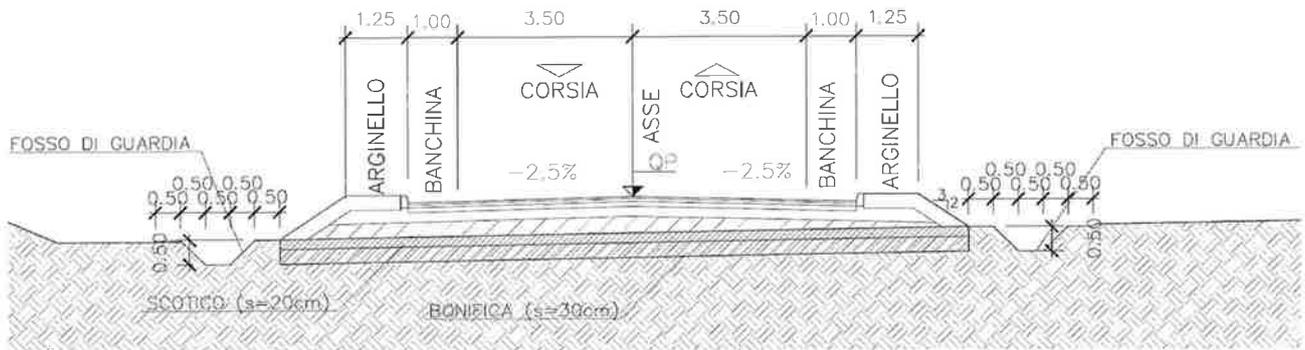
Sezione tipo "locale a destinazione particolare" (D.M. 5/11/2001) in rilevato
